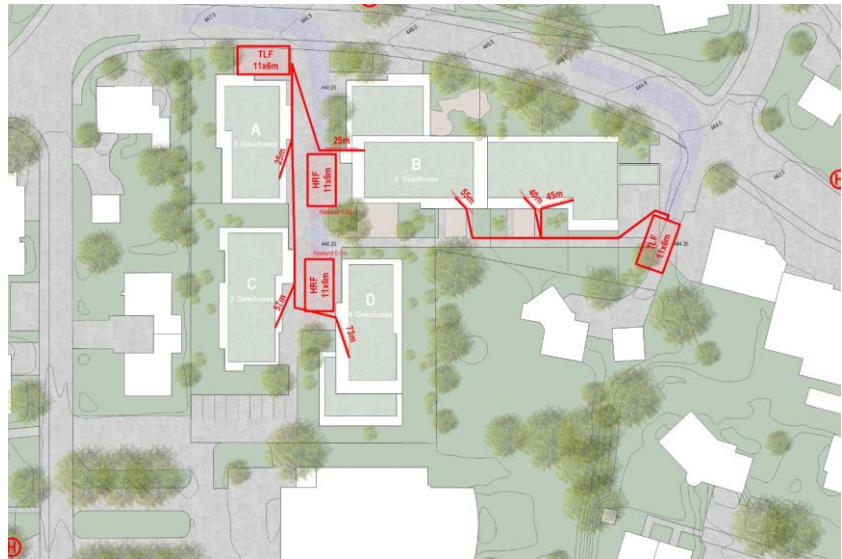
Feuerwehruzufahrten (siehe Beilage 3)
